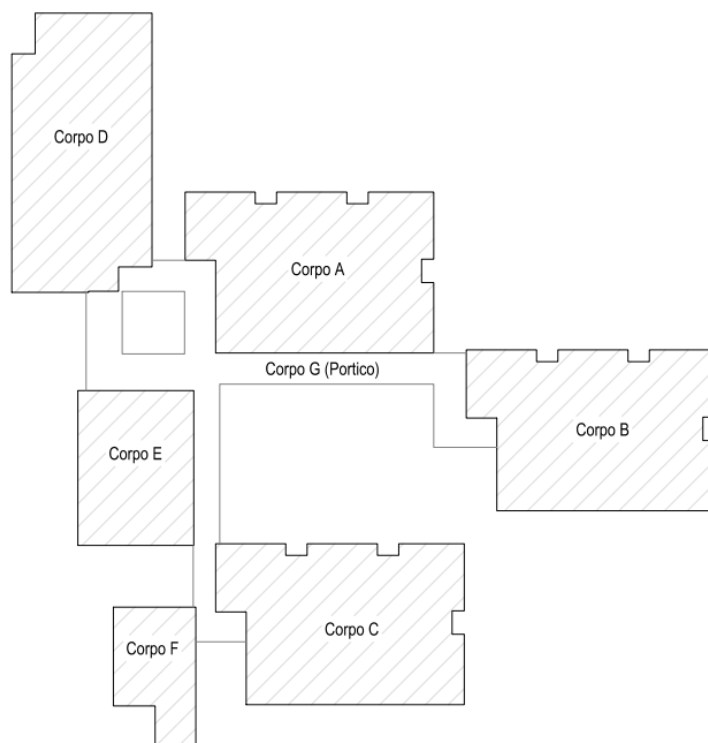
schema planimetrico con identificazione dei corpi strutturali
